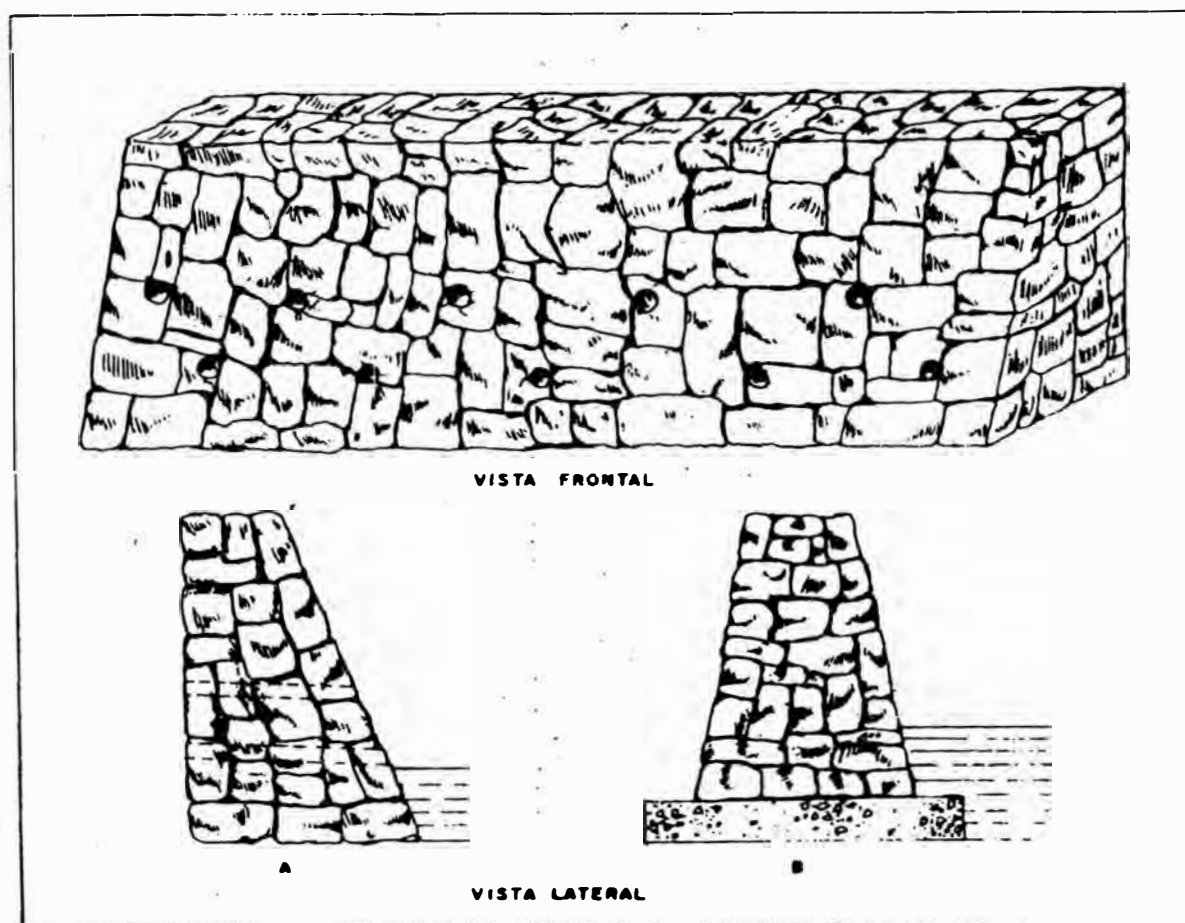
Visto Frontal y lateral de un muro de mampostería
